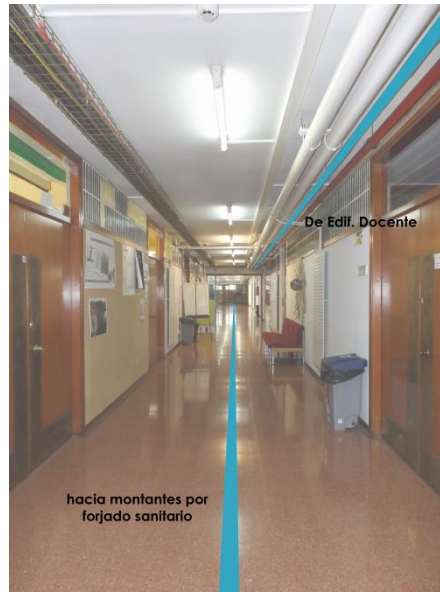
Distribución por forjado sanitario. (Elaboración propia)
